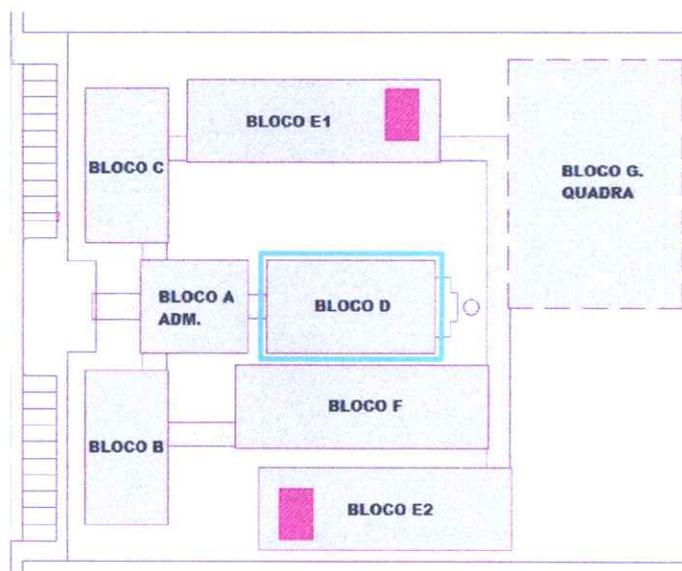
Layout dos Blocos, conforme Projeto de Arquitetura. Fonte: Projeto Padrão FNDE.
